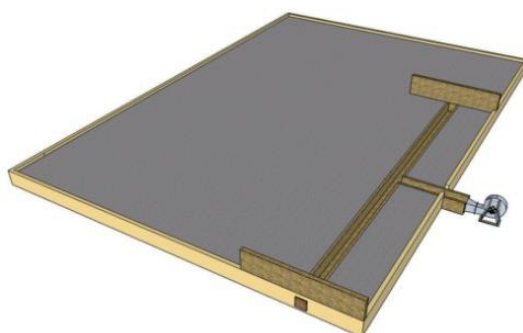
Construção dos canais (túneis) do terreiro híbrido abaixo do nível do terreiro convencional.
